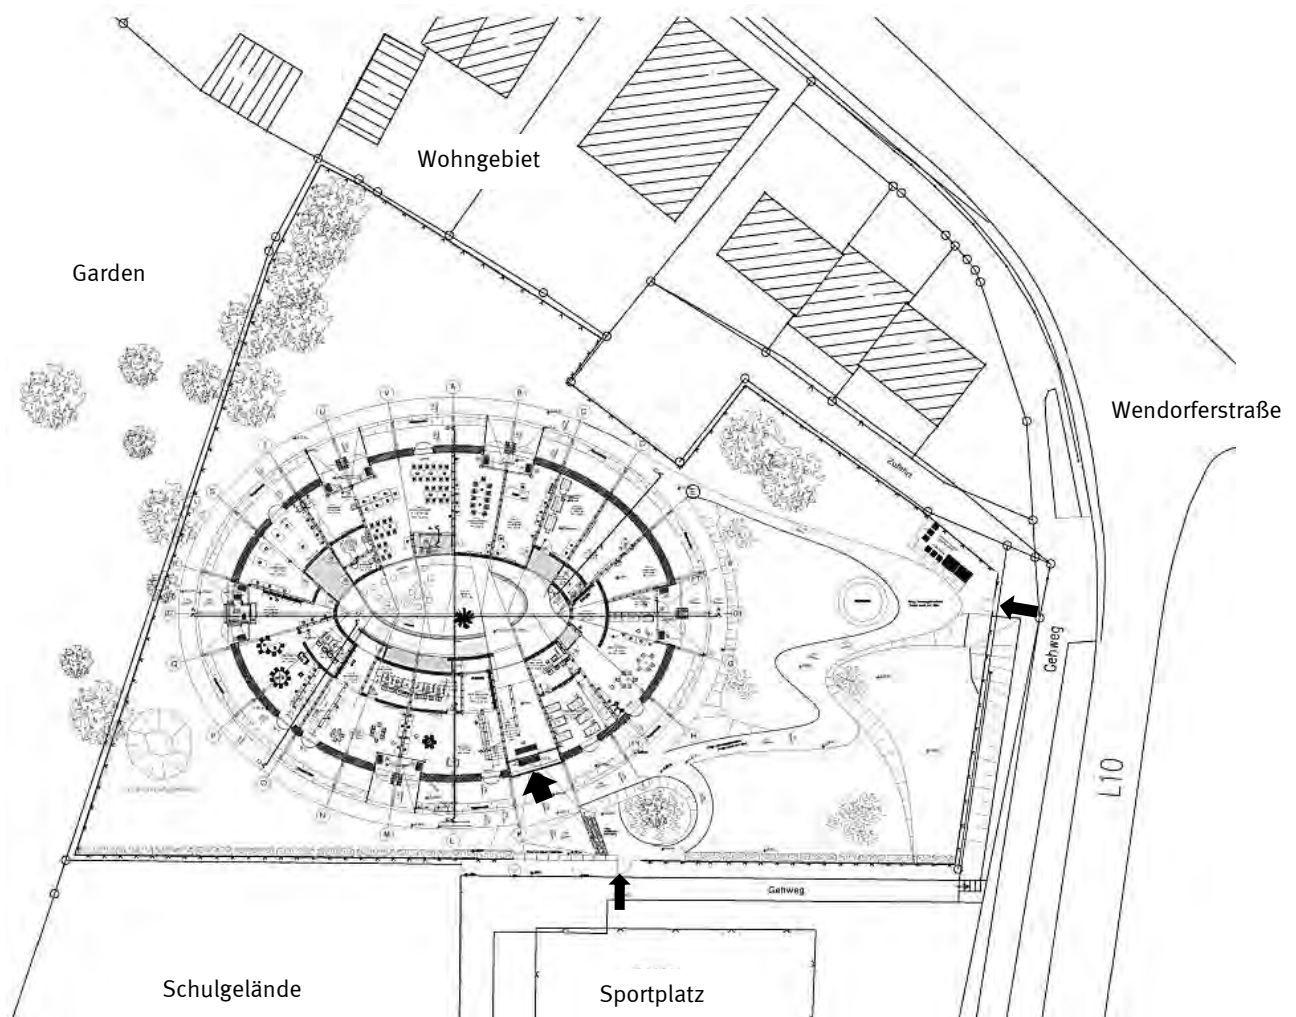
Lageplan – Kindertagesstätte „Wildblume“
